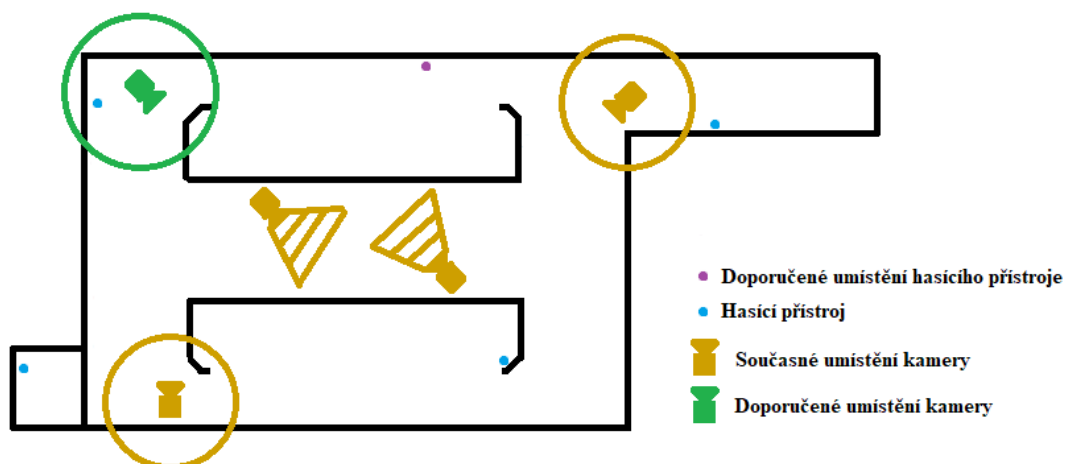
Parkovací dům – poschodí -1. [vlastní]
